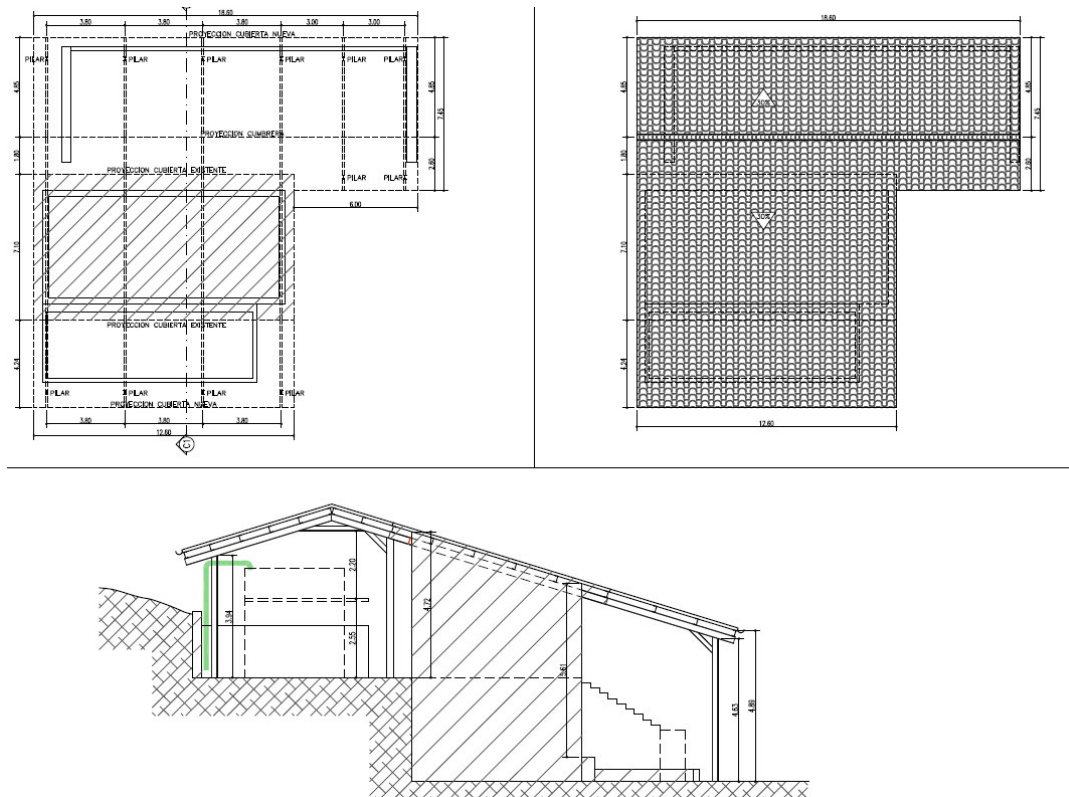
Estado actual y propuesta para la construcción de la cubierta. Facilitado por Arquitrabe Ingeniería para la realización del estudio geotécnico.
